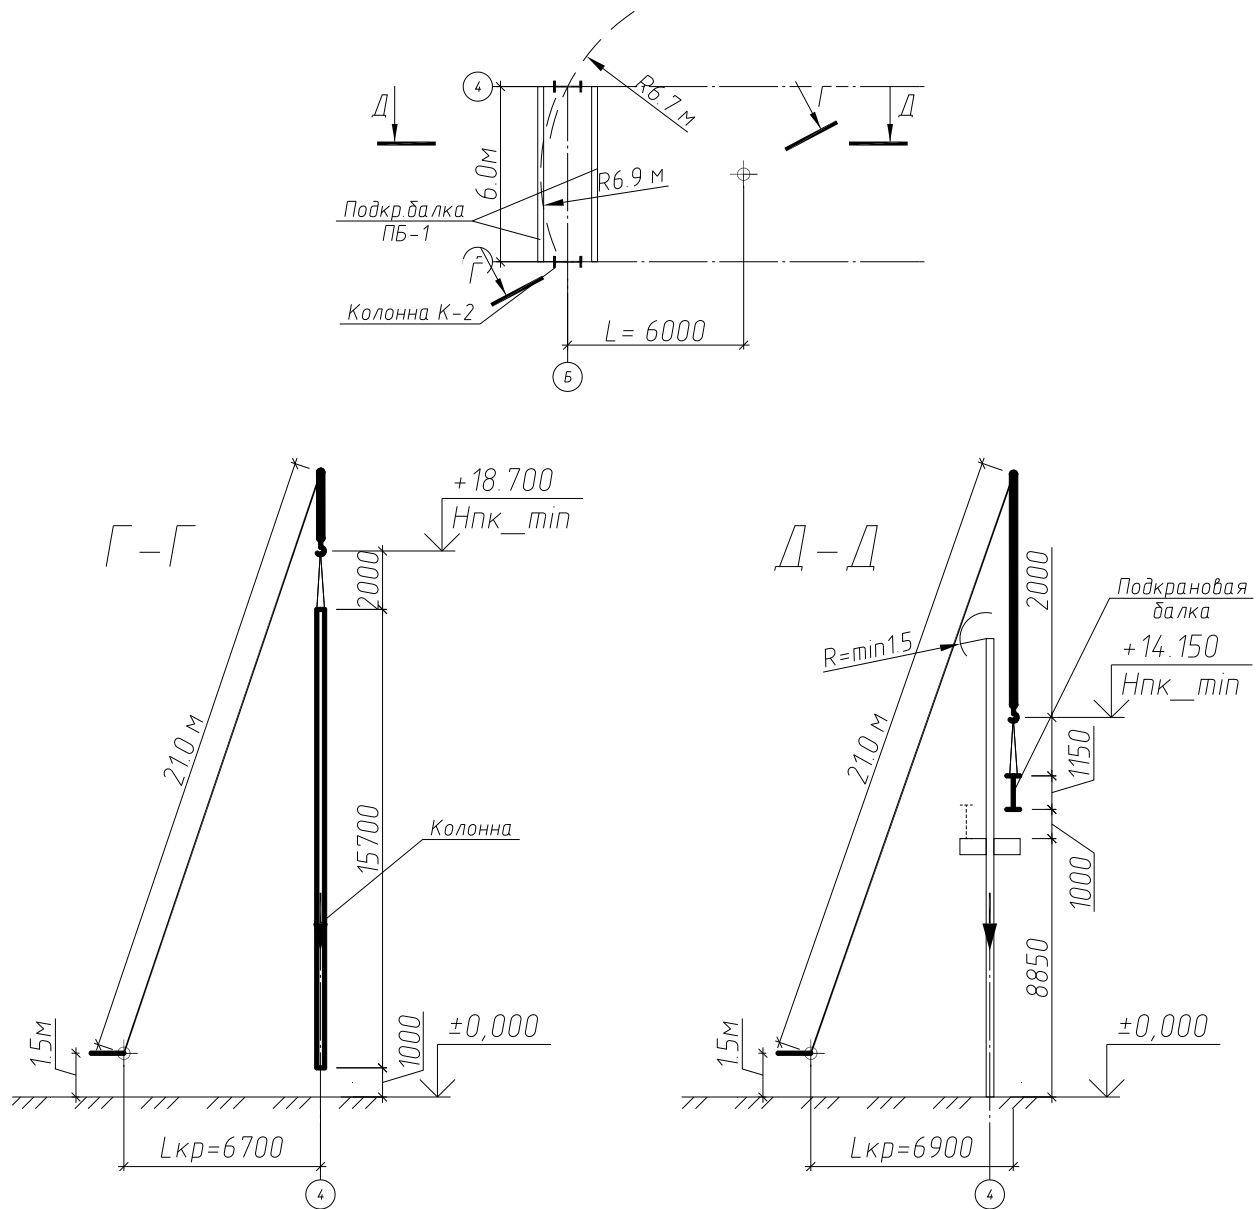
К выбору крана при монтаже колонн и подкрановых балок с одной стоянки
